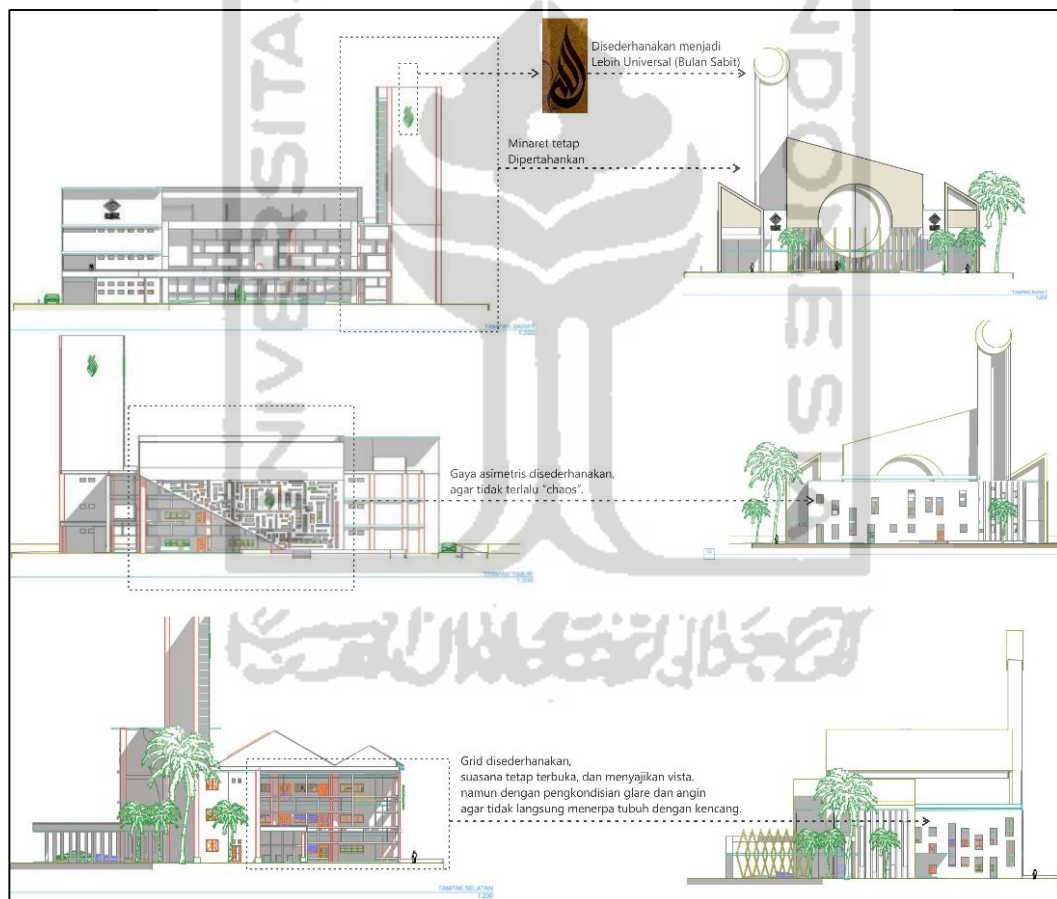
(Revisi) - Alternatif Rancangan Façade
